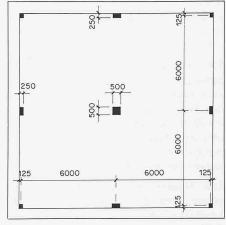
Flachdecke. Grundriss. Abmessungen [mm]
